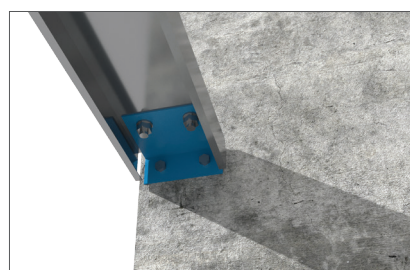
Szczegóły połączenia słupa z belką okapową, stanowiącą część głównej konstrukcji betonowej. Słup połączony jest za pomocą kątownika przyspawanego do płyty stalowej stanowiącej część płatwi betonowej. Alternatywnie, kątownik ten może być przymocowany do płatwi betonowej za pomocą kotew chemicznych lub kołków rozporowych. Słup połączony jest z kątownikiem za pomocą pary śrub M16. W razie potrzeby można wykorzystać dwie pary śrub M16.
